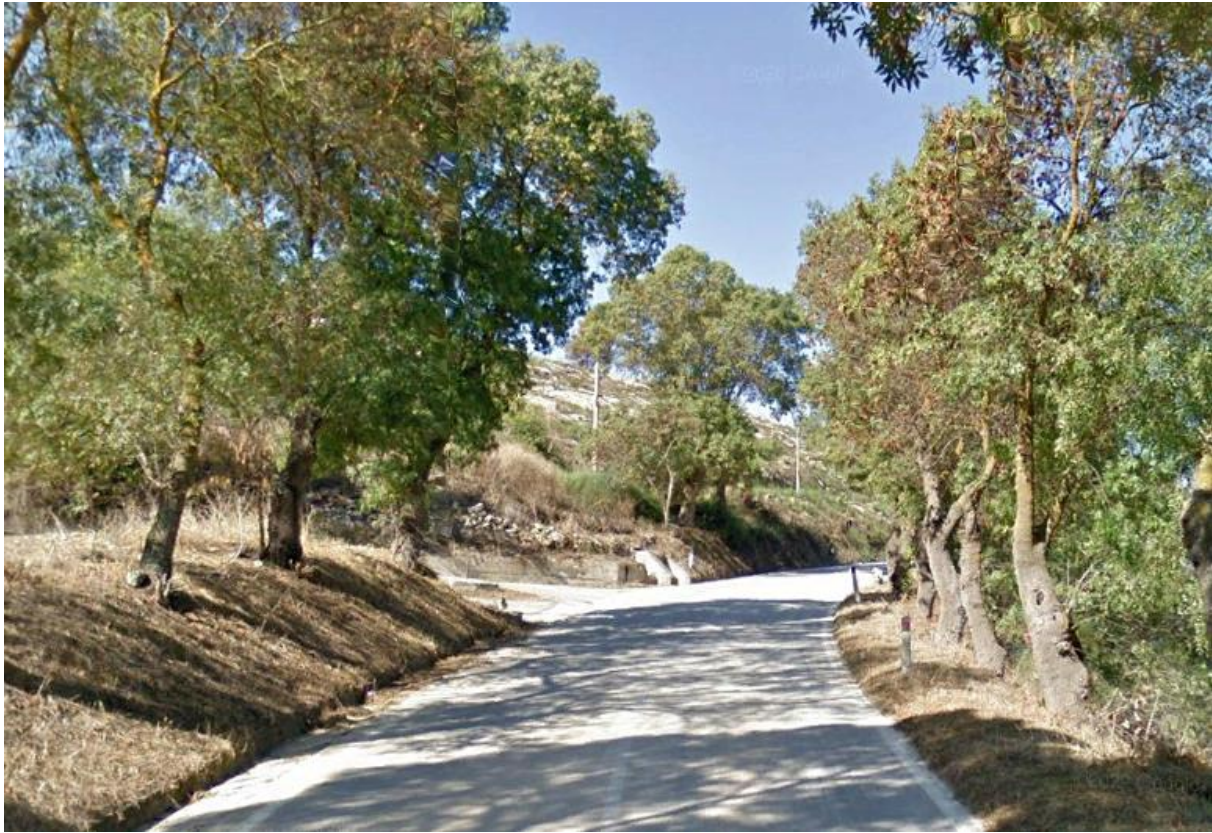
Tratto della SS188 interessato dall'attraversamento del cavidotto
